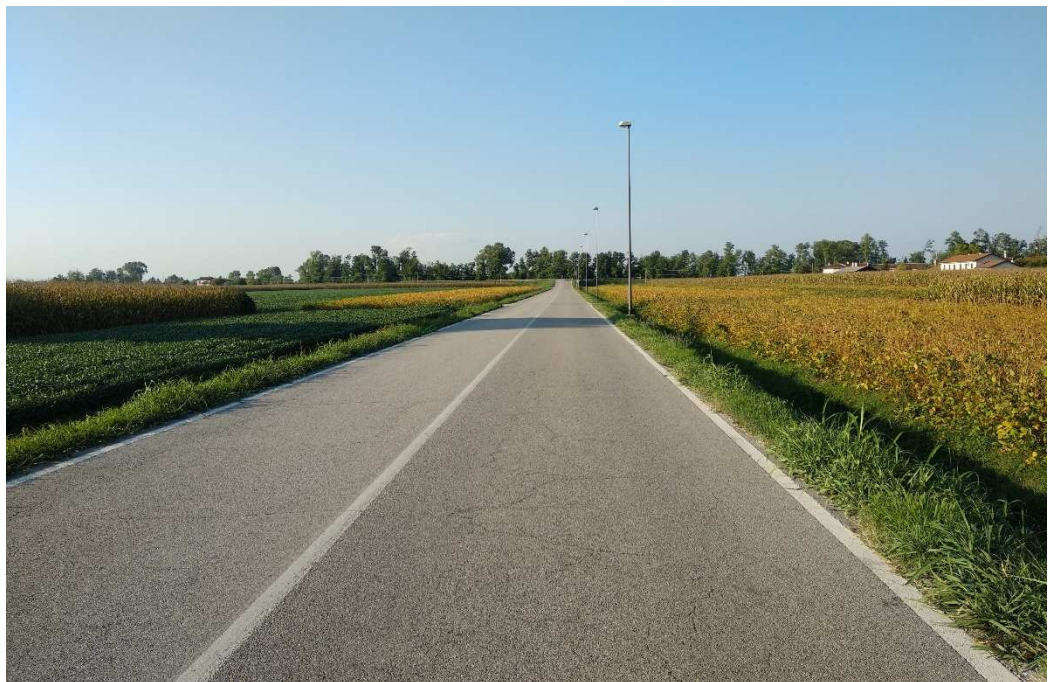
Foto strada di accesso alla discarica di Piave Nuovo
